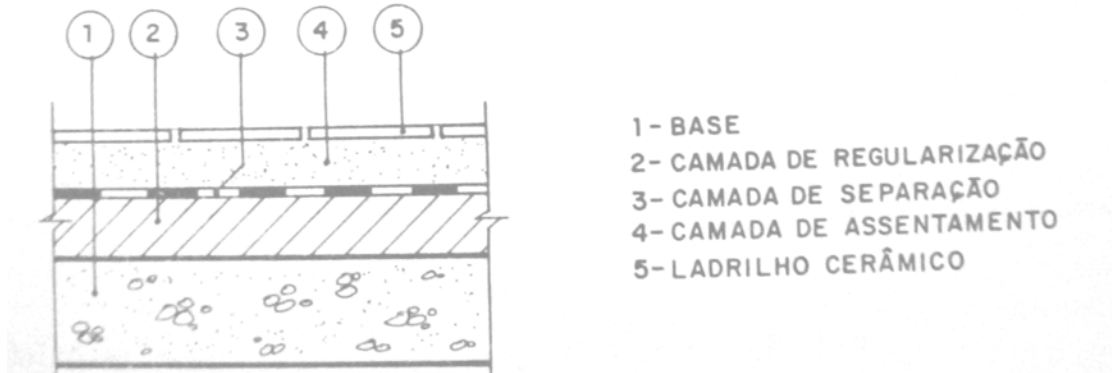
Camada de separação entre o piso cerâmico e laje de concreto armado
